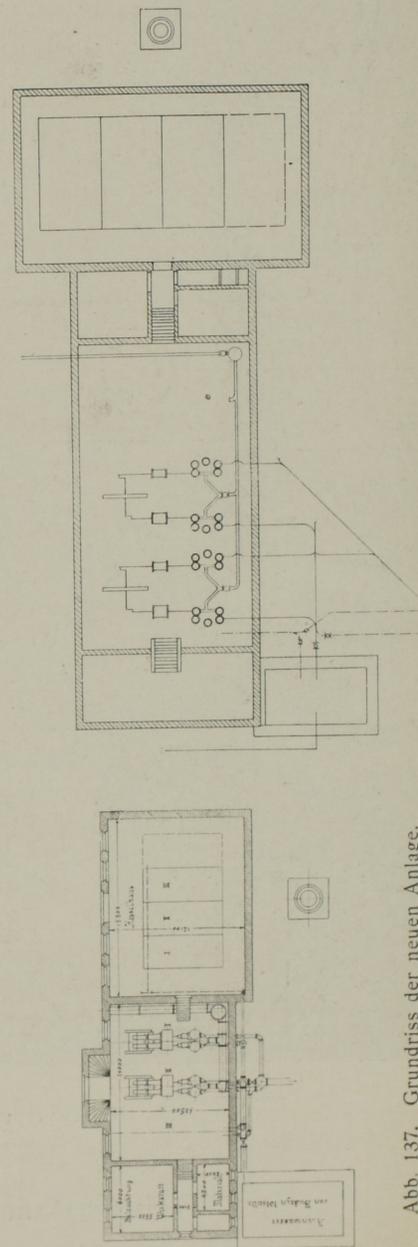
Grundriss der Anlage nach d. ursprüngl. Projekt. Masst. 1:500.
